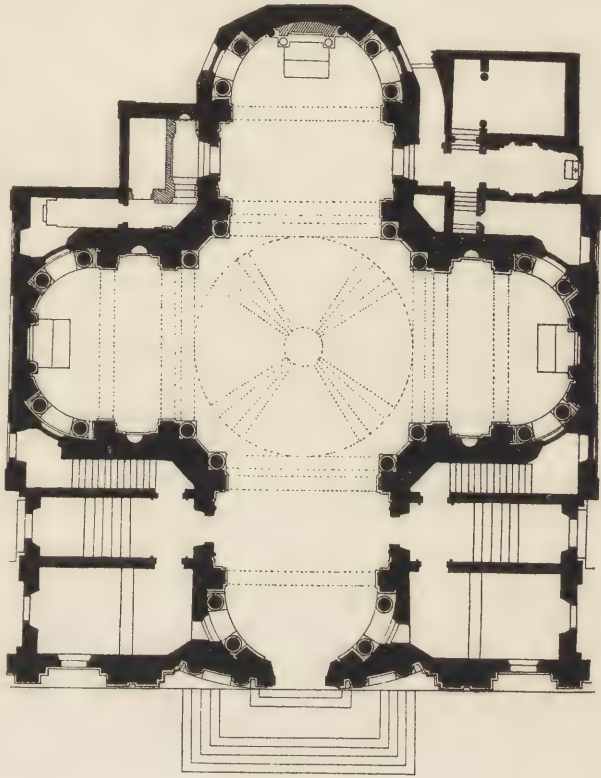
St. Luca e Martina zu Rom. Grundriss.
